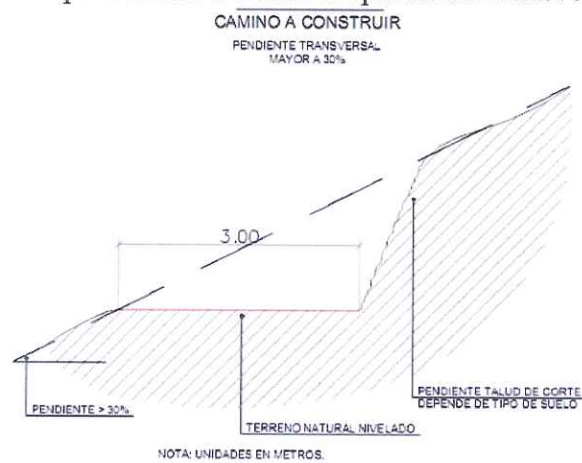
Perfil Tipo Camino a Construir pendiente transversal mayor a 30%
